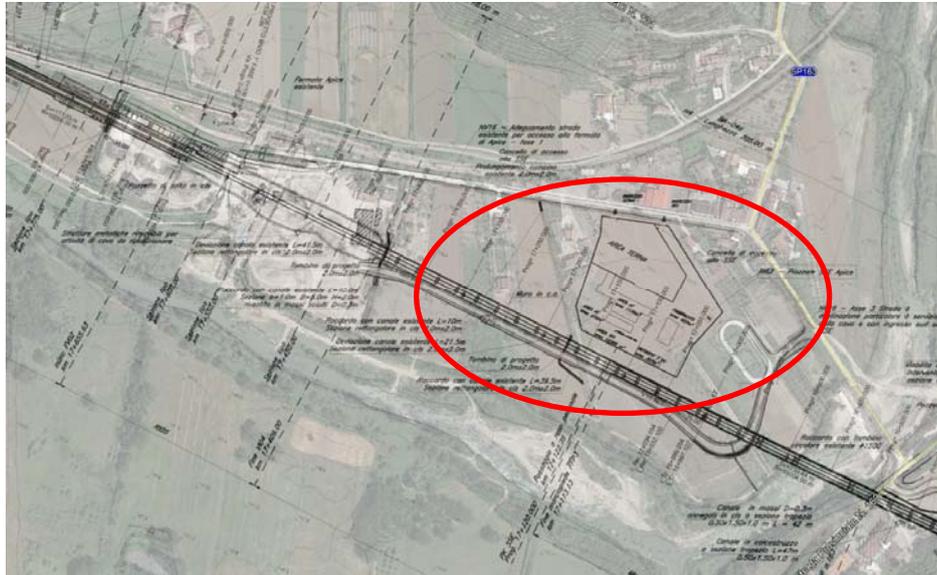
Individuazione su foto aerea dell'ambito di progetto interessato dalla prescrizione
